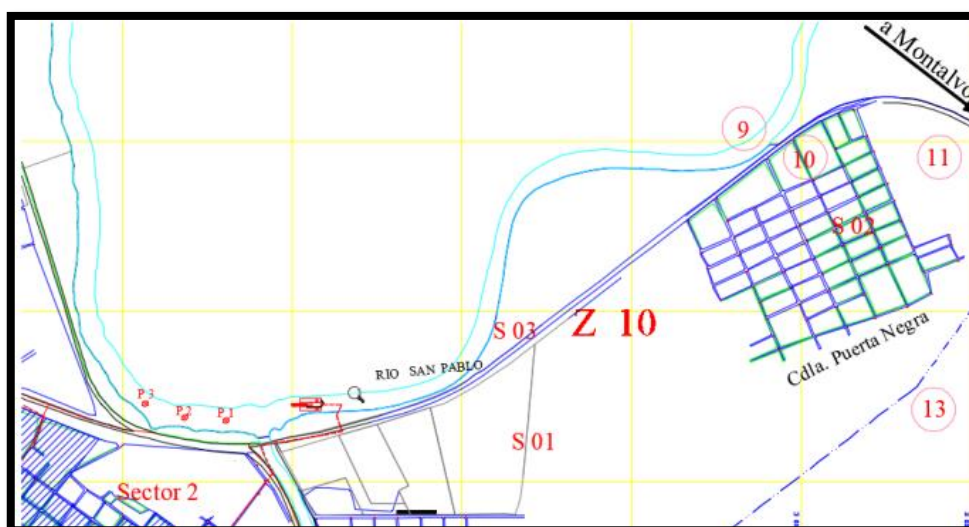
Plano de ubicación de la draga en el río San Pablo. Fuente Dragas
